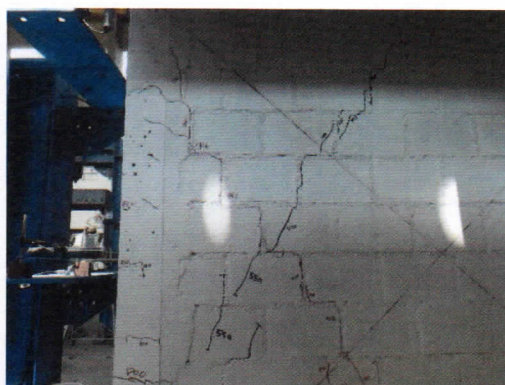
Formación de grietas diagonales en el lado Este de la cara Norte para una distorsión de 1/550.
